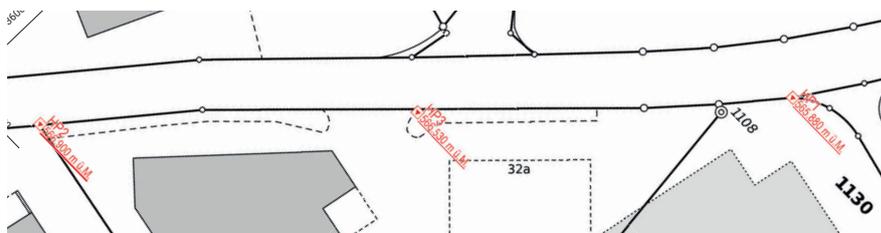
Aufnahme der Terrainhöhen entlang der Kantonstrasse/Areal Garage Pieren (Quelle: Dütschler und Partner Dezember 2022, Planausrichtung Nord-Nord-West)
